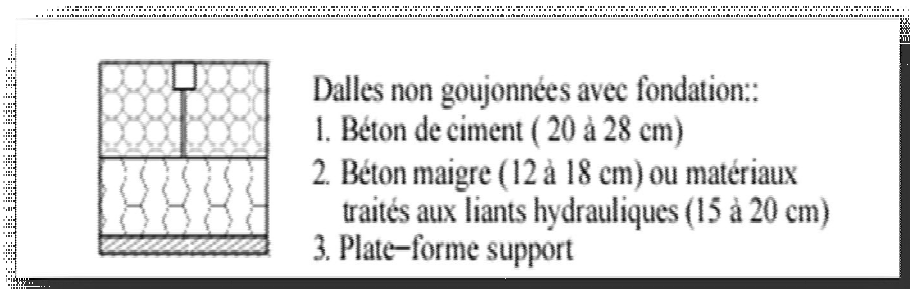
Dalles non goudronnées avec fondation [LCPC, 1994][1]
